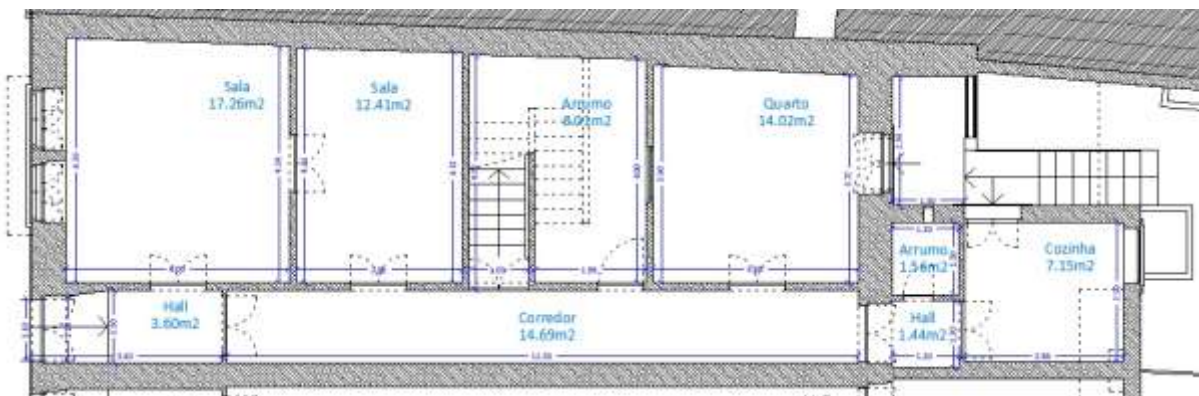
Dimensões em planta para a verificação da zona de permanência e largura livre do piso 1 (SRU, 2023).
